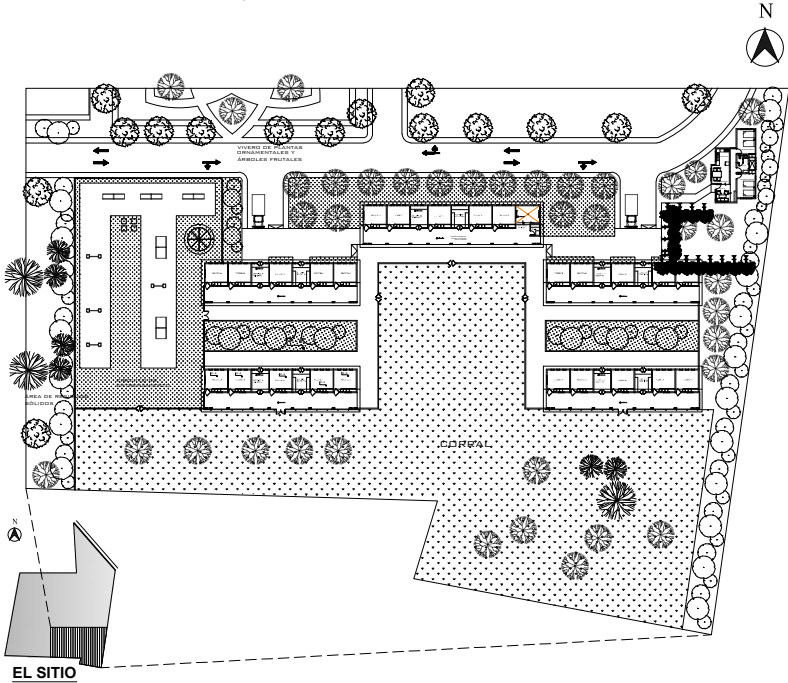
Planta de conjunto, zona de equinos propuesta. Fuente: Elaboración propia.
